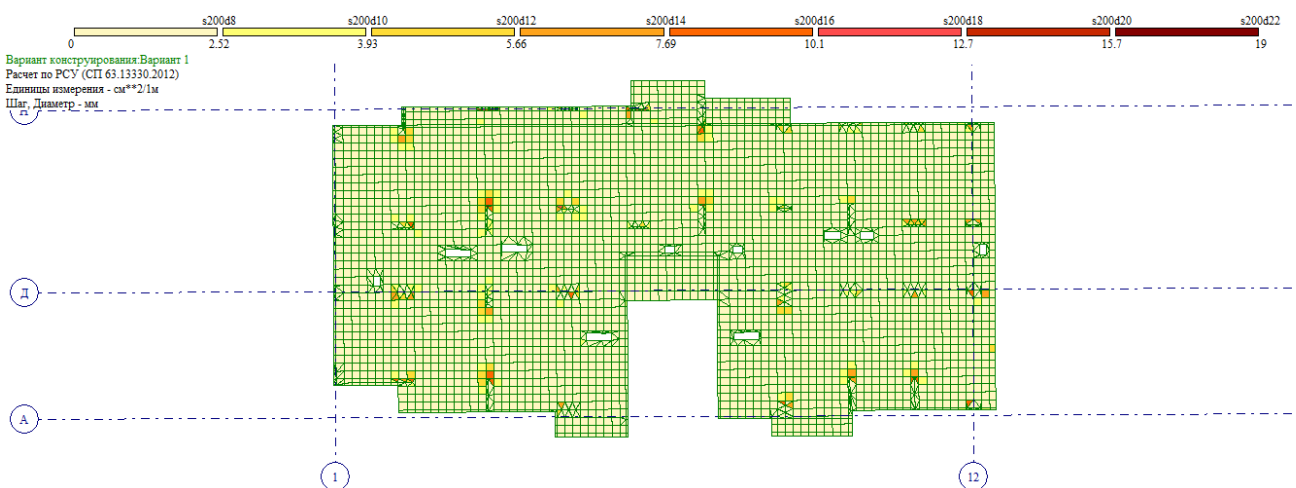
Верхнее армирование плиты по оси Y1
